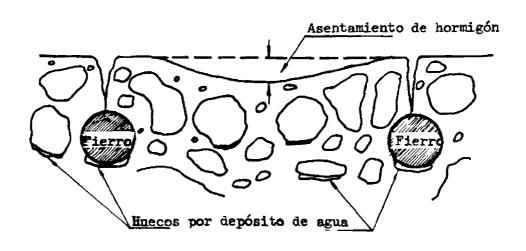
GRIETAS SOBRE LAS ARMADURAS POR SECADO PREMATURO DEL HORMIGON
